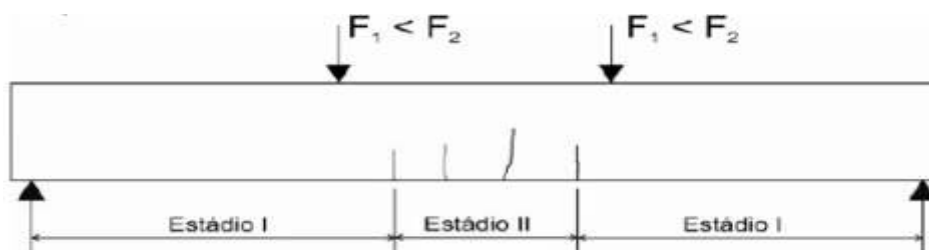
Início do estágio de fissuração (fissuras verticais de flexão pura)
